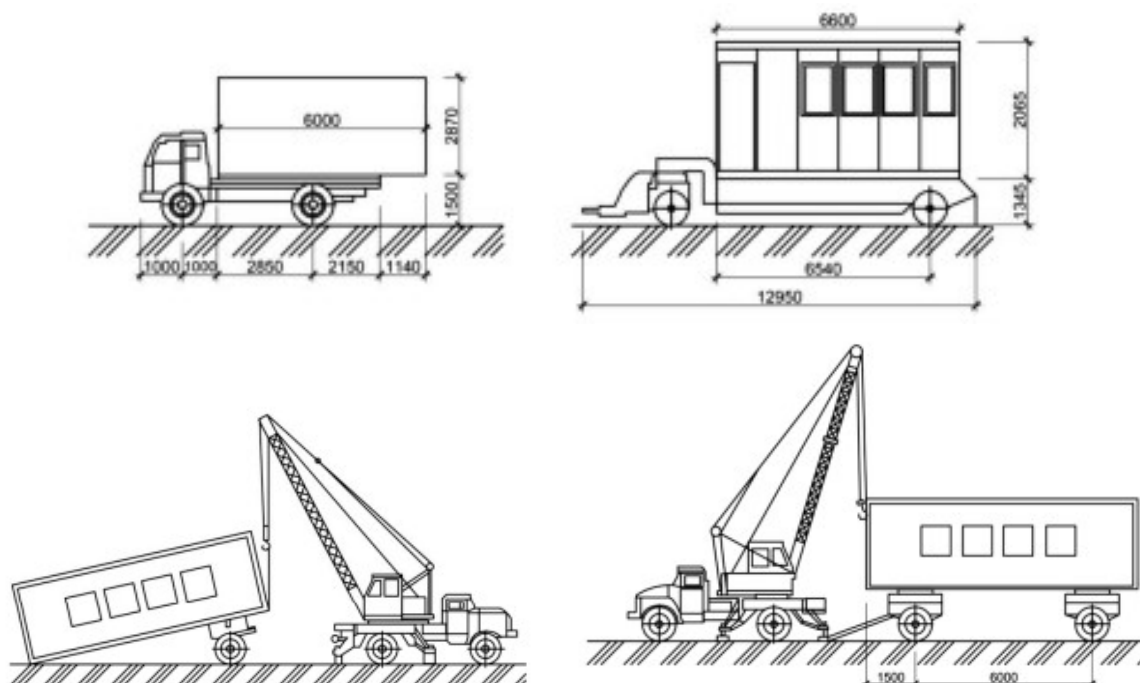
Схема погрузки и разгрузки передвижных зданий стреловым краном
